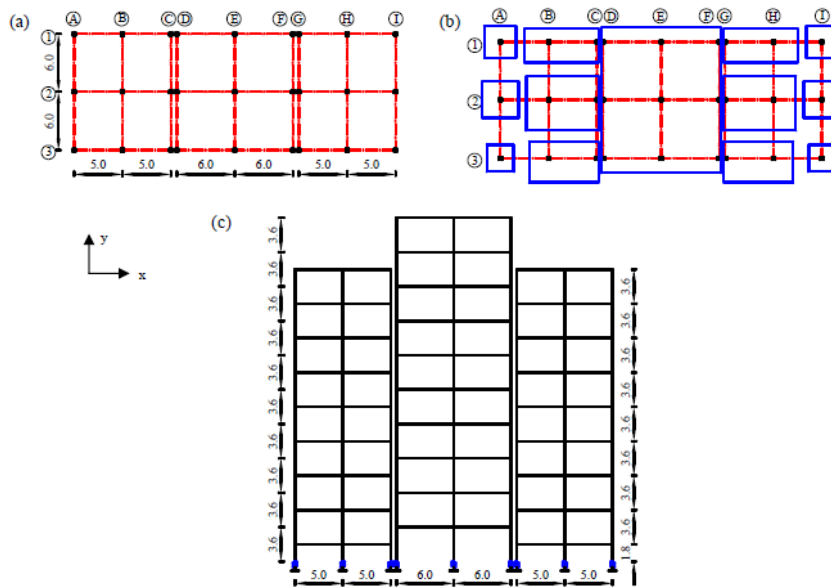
a) Vista en planta, b) Diseño de la cimentación, c) elevación de los edificios (Shakya *et al.* 2008)
